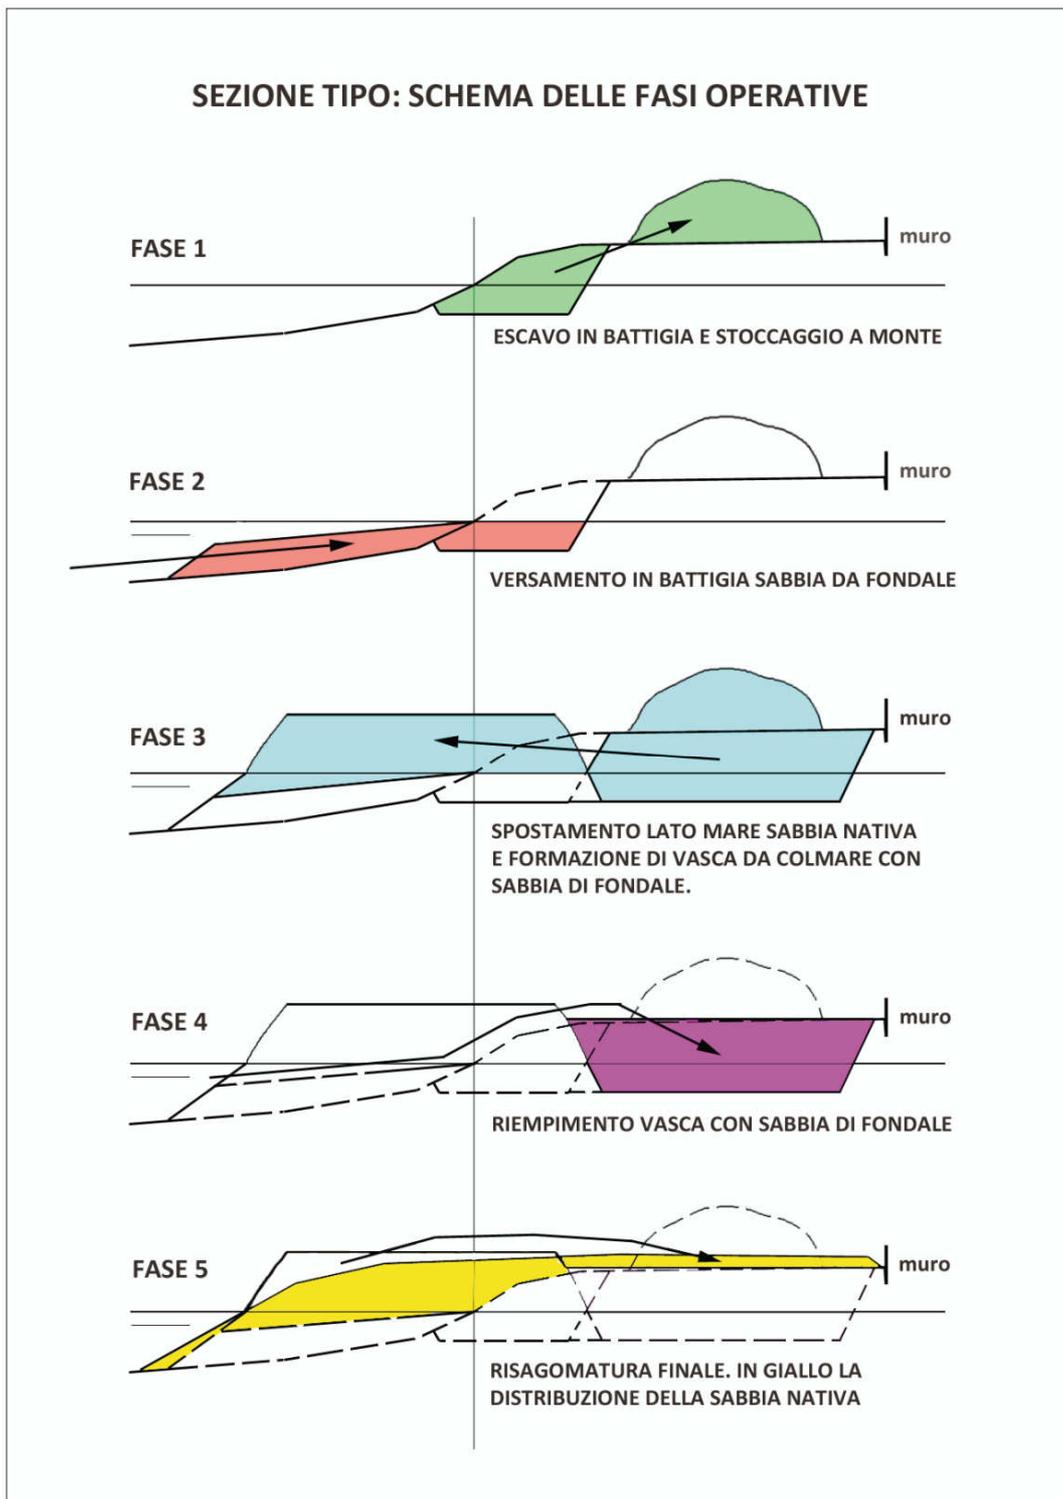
Sezione tipo – Schema delle fasi esecutive
